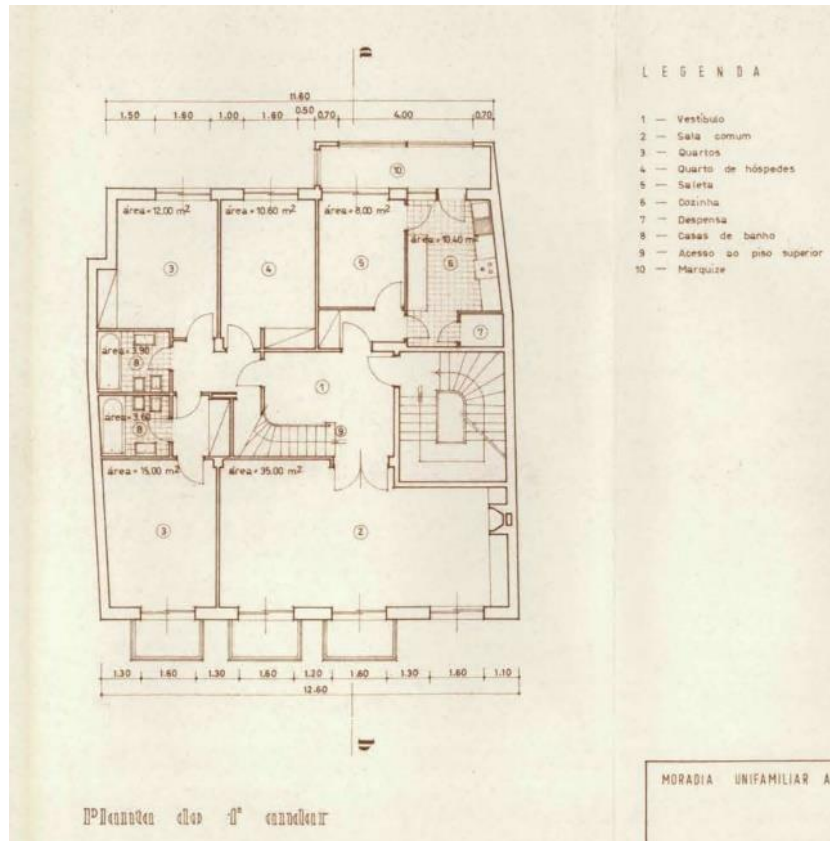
Planta de Levantamento, Piso 1, fonte Câmara Municipal de Leiria¹
